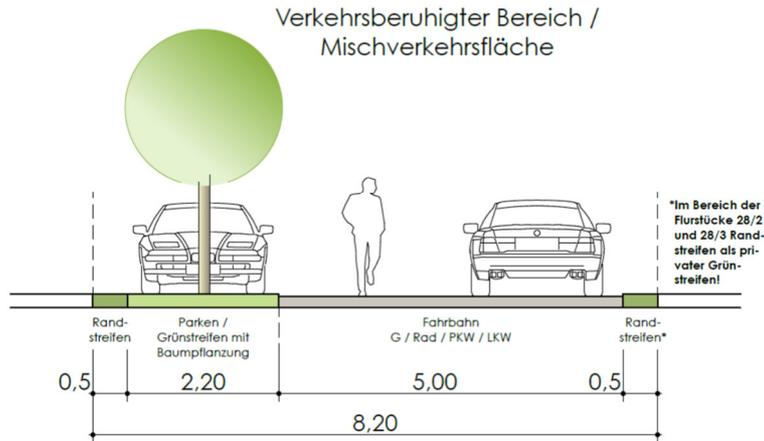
Innere Erschließung des Plangebietes (Quelle: ASSW B-Plan 2020).
